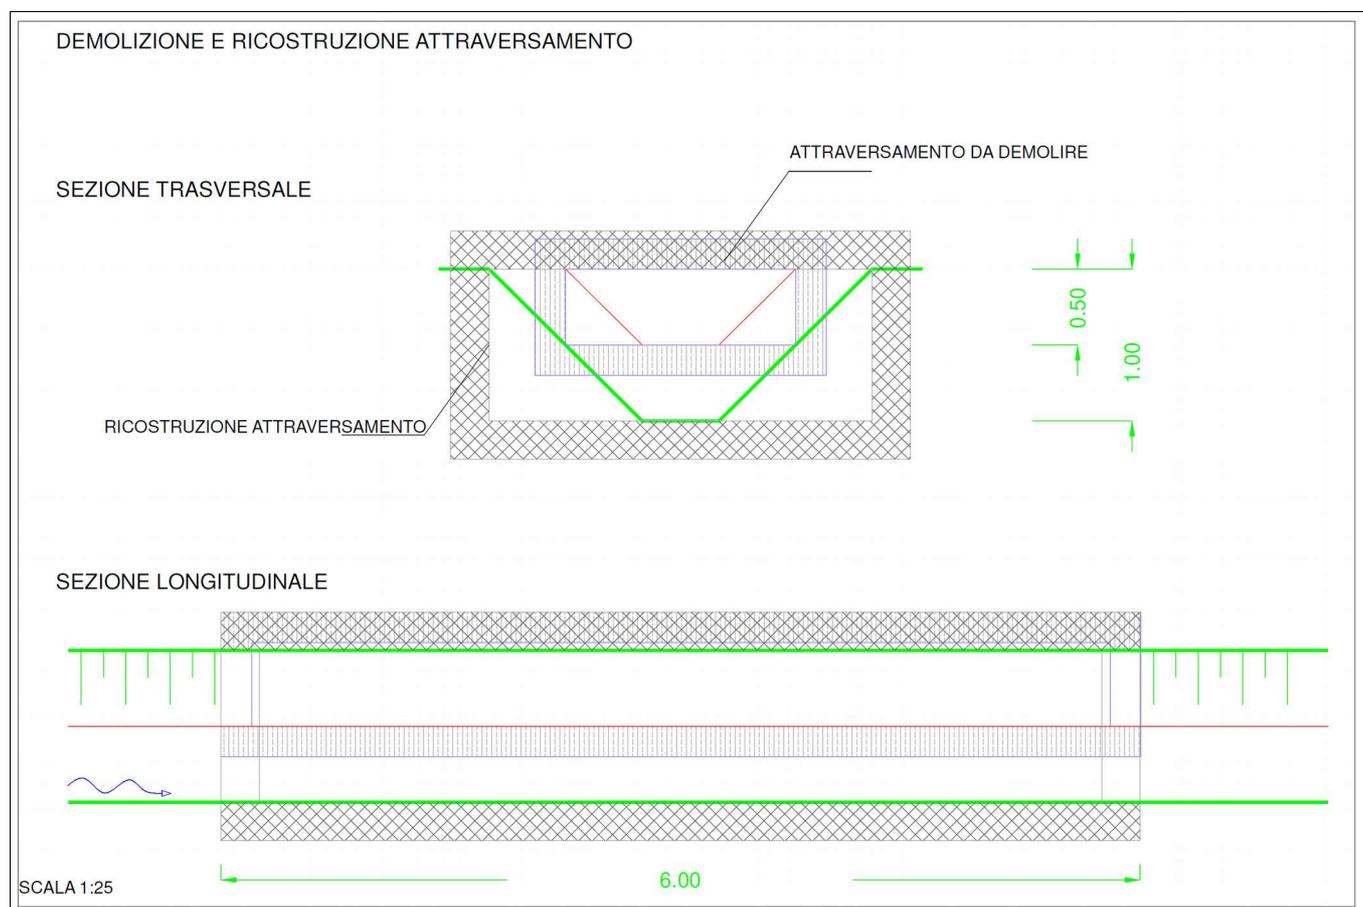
Sezione Tipo Intervento sistemazione adeguamento attraversamenti
